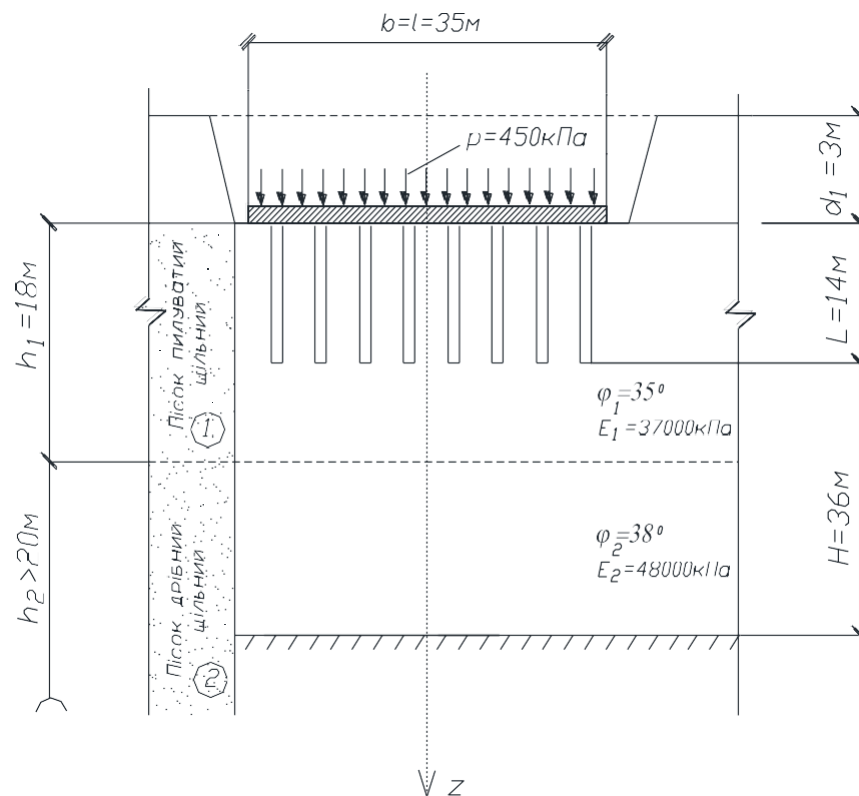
Варіант 1 закладання пально-плитного фундаменту в ІГЕ-1
